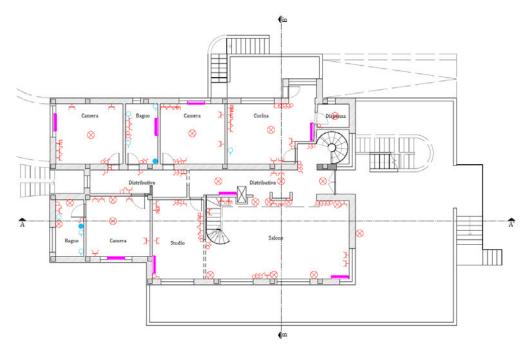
Piano Primo con indicazione dei dispositivi rilevati.
